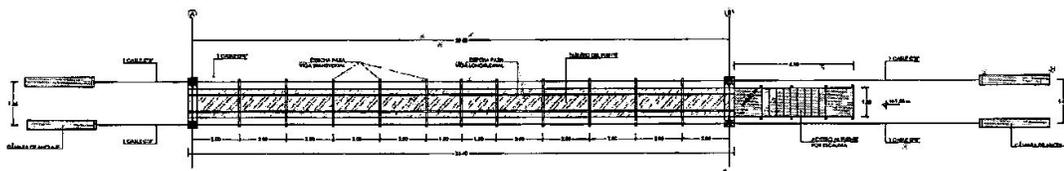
Vista en planta del puente colgante peatonal - Quebrada San Francisco⁹
